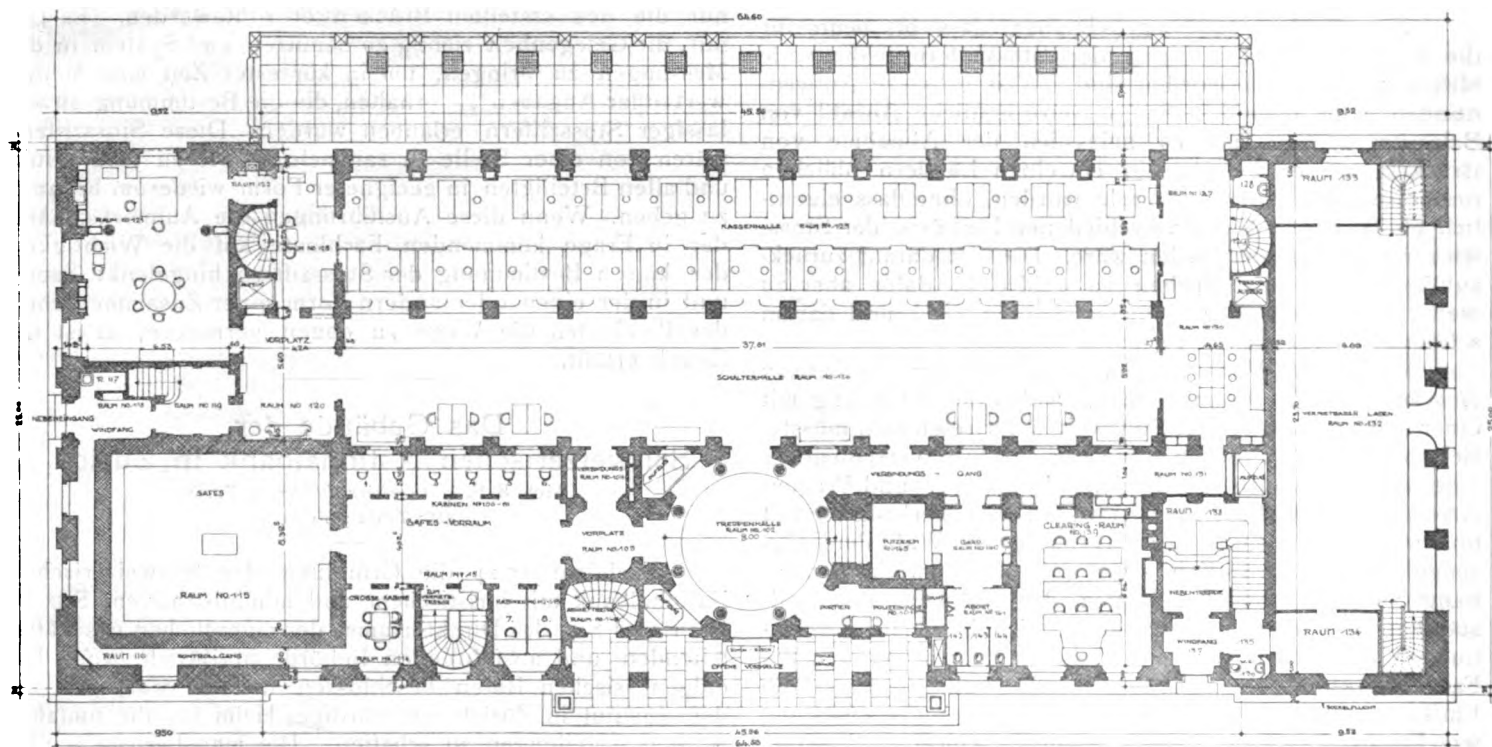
Grundriss vom Erdgeschoss der Schweiz. Nationalbank in Zürich. — Masstab 1 : 350
